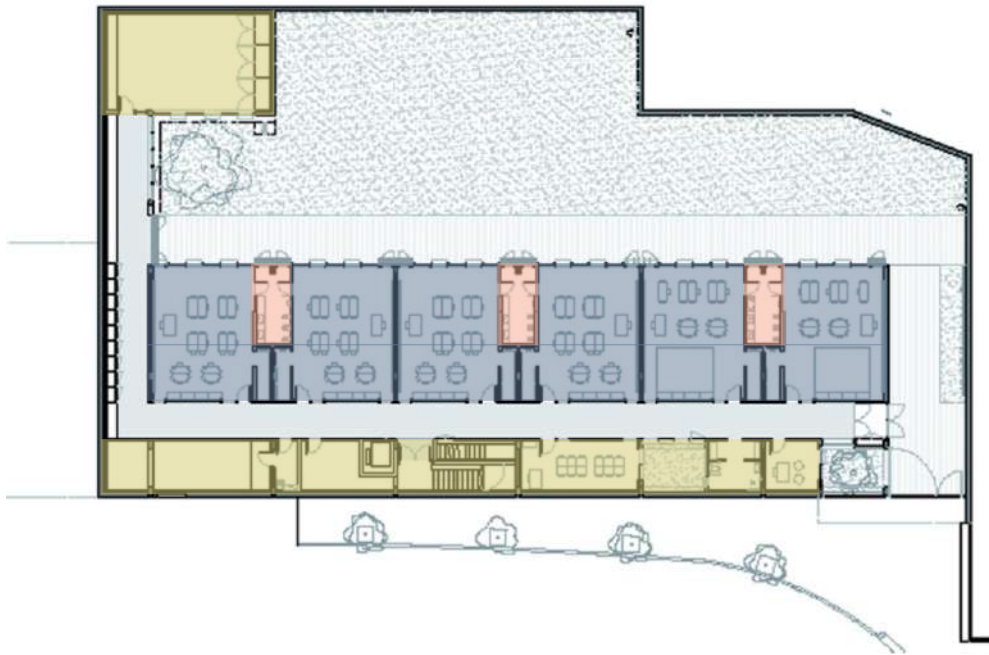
Planta baixa subsolo - Fonte: Archdaily, 2014
